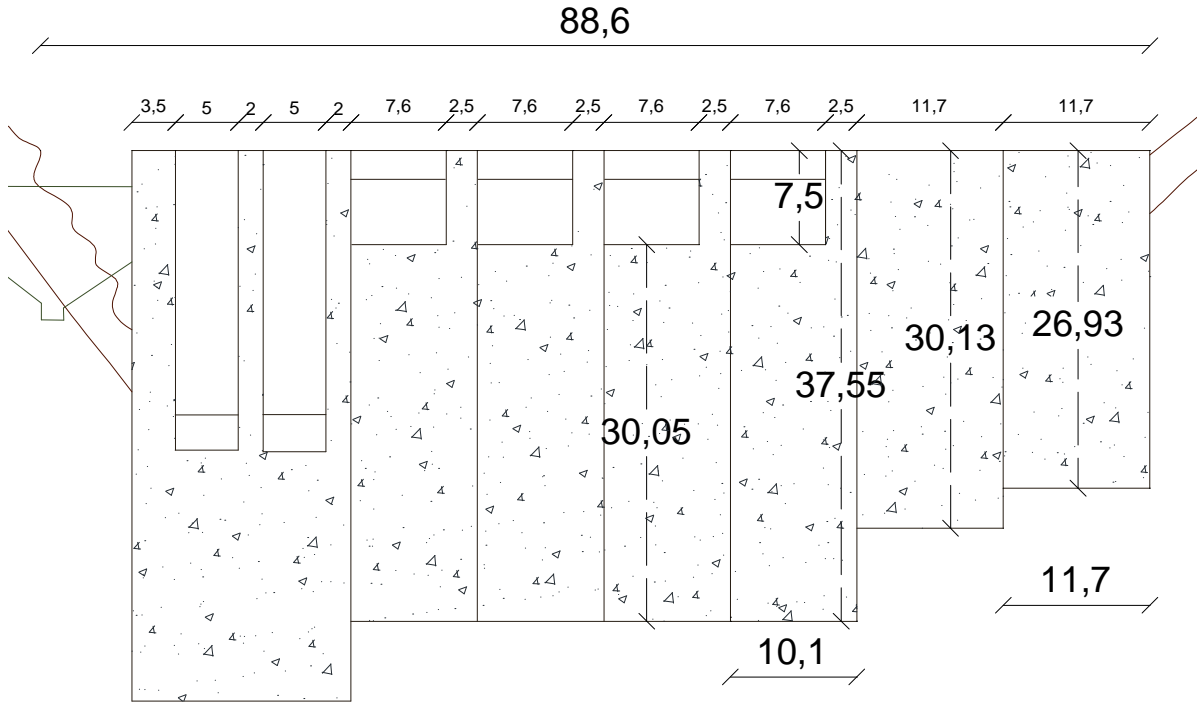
6 Sección Longitudinal y Dimensiones de la Presa Santa Cruz
